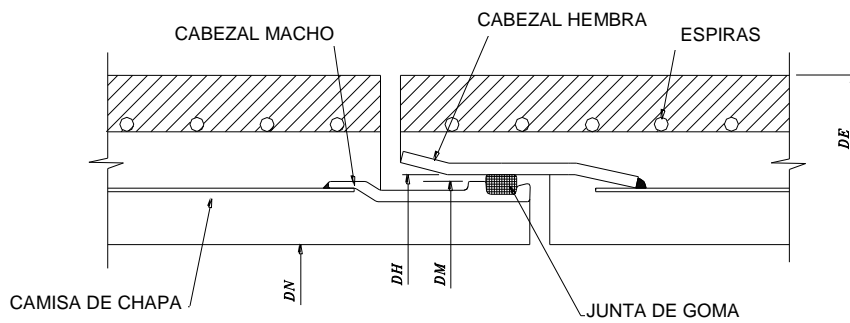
Tubería de hormigón postesado tipo DELTA.
